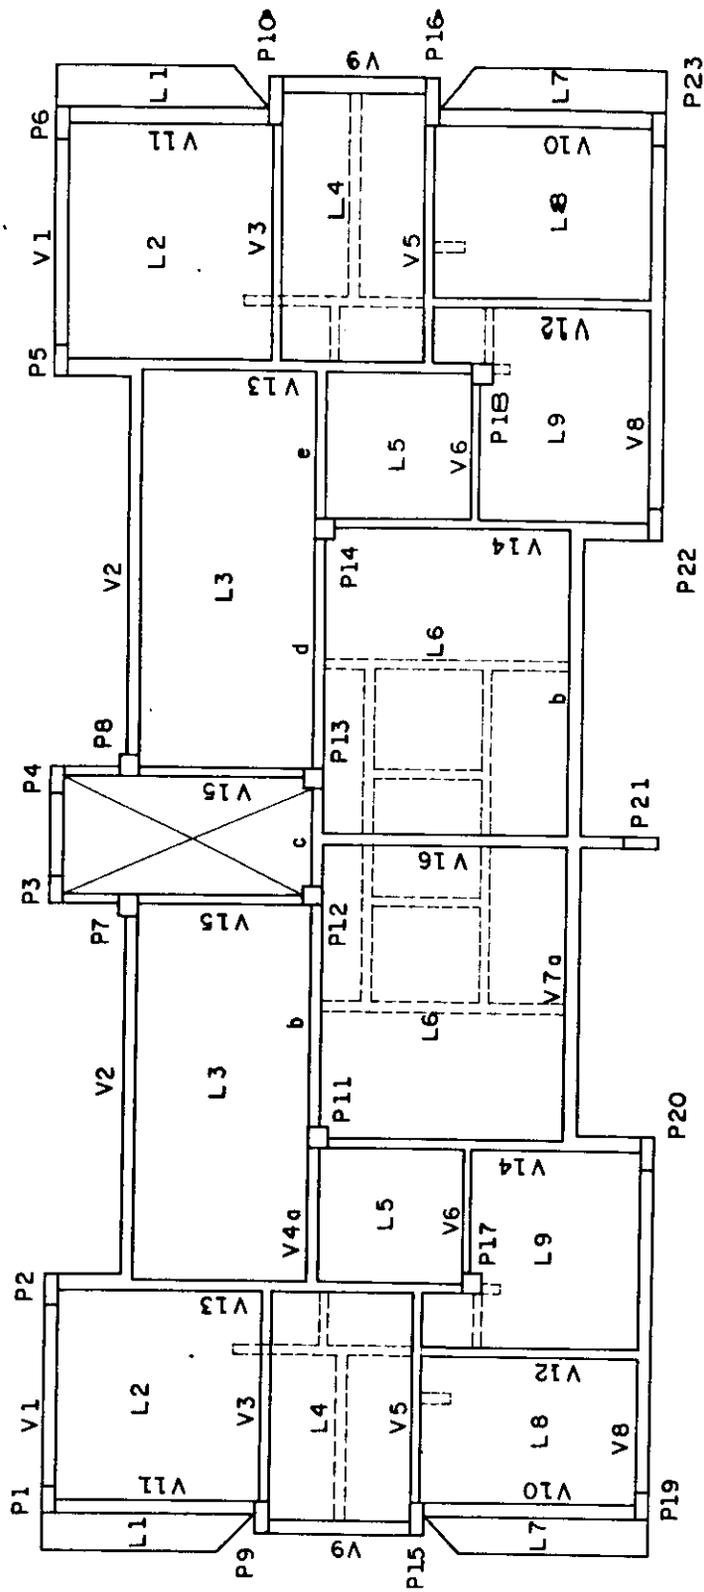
Estrutura II - Pavimento Tipo Edifício B
